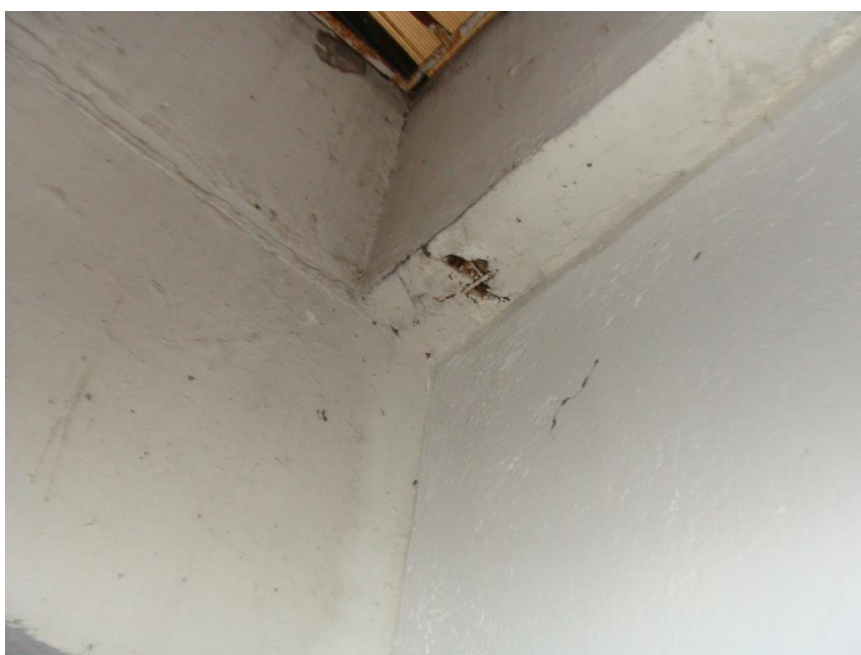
Exposição e corrosão de armaduras na Laje L17 (25/02/2021)
